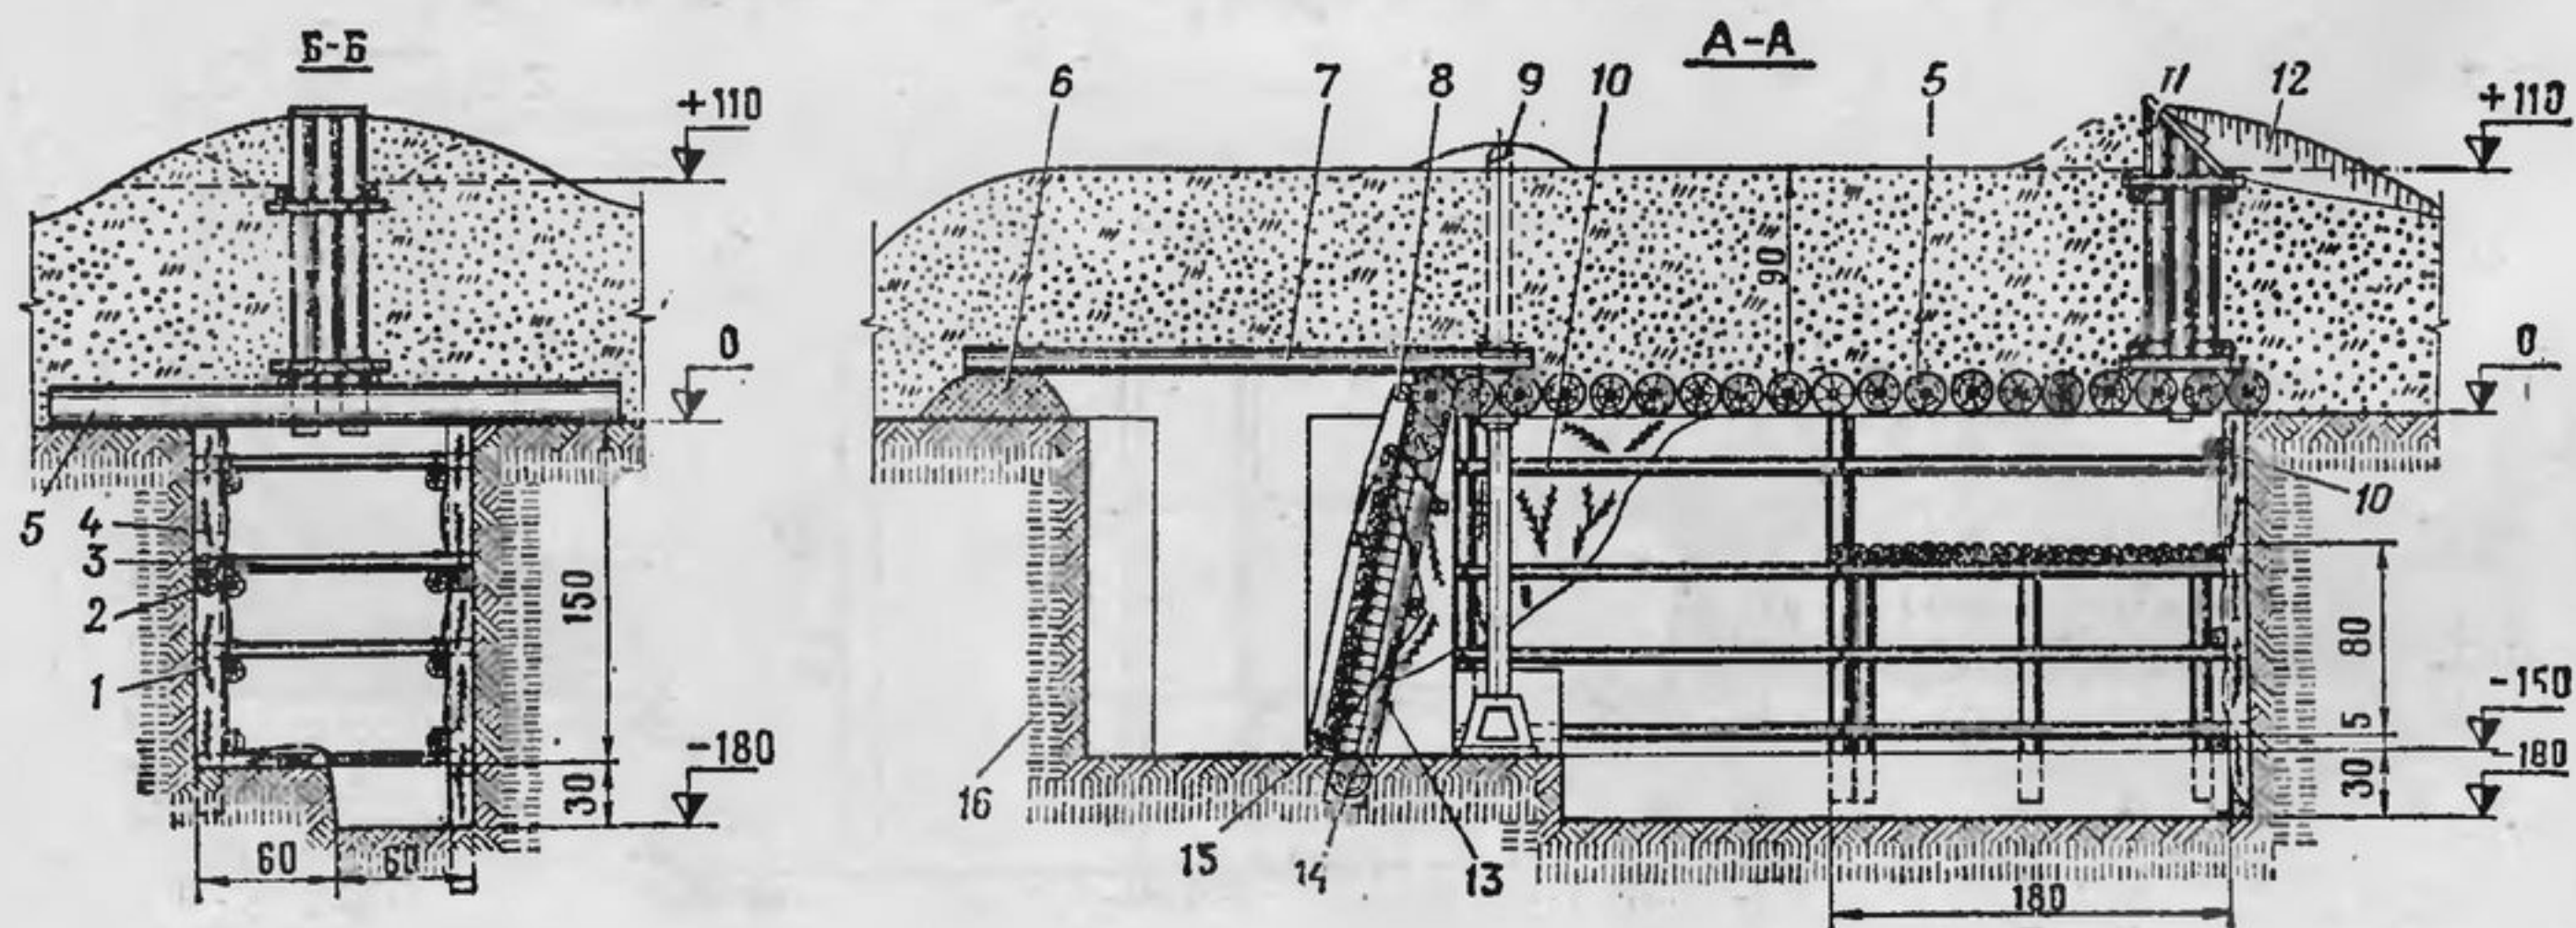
Бляндаж с перекрытием из круглого леса, возводимый в мерзлом грунте:
